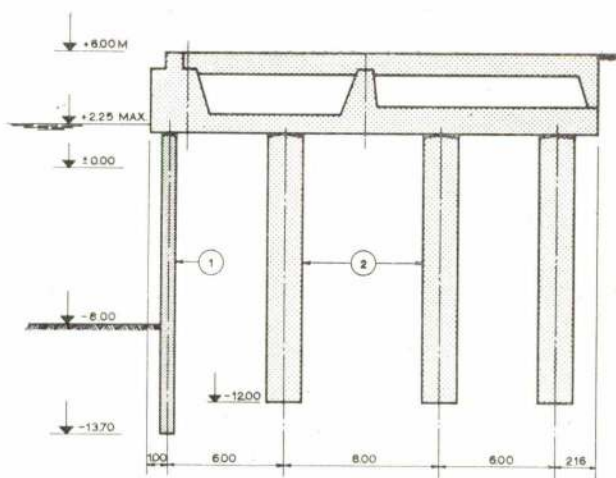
Cais de Batán, Sevilha. 1 — Parede moldada no solo; 2 — Estacas formadas por elementos de parede moldada. (Doc. Rodio).
